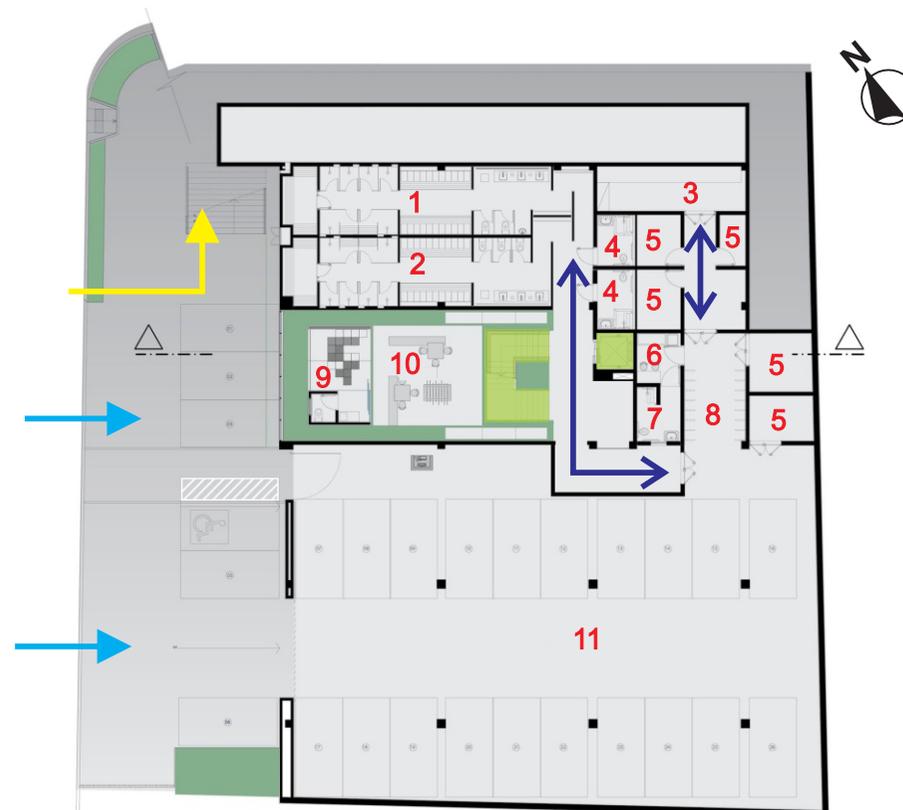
Planta baixa Subsolo. Fonte: Site Archdaily
